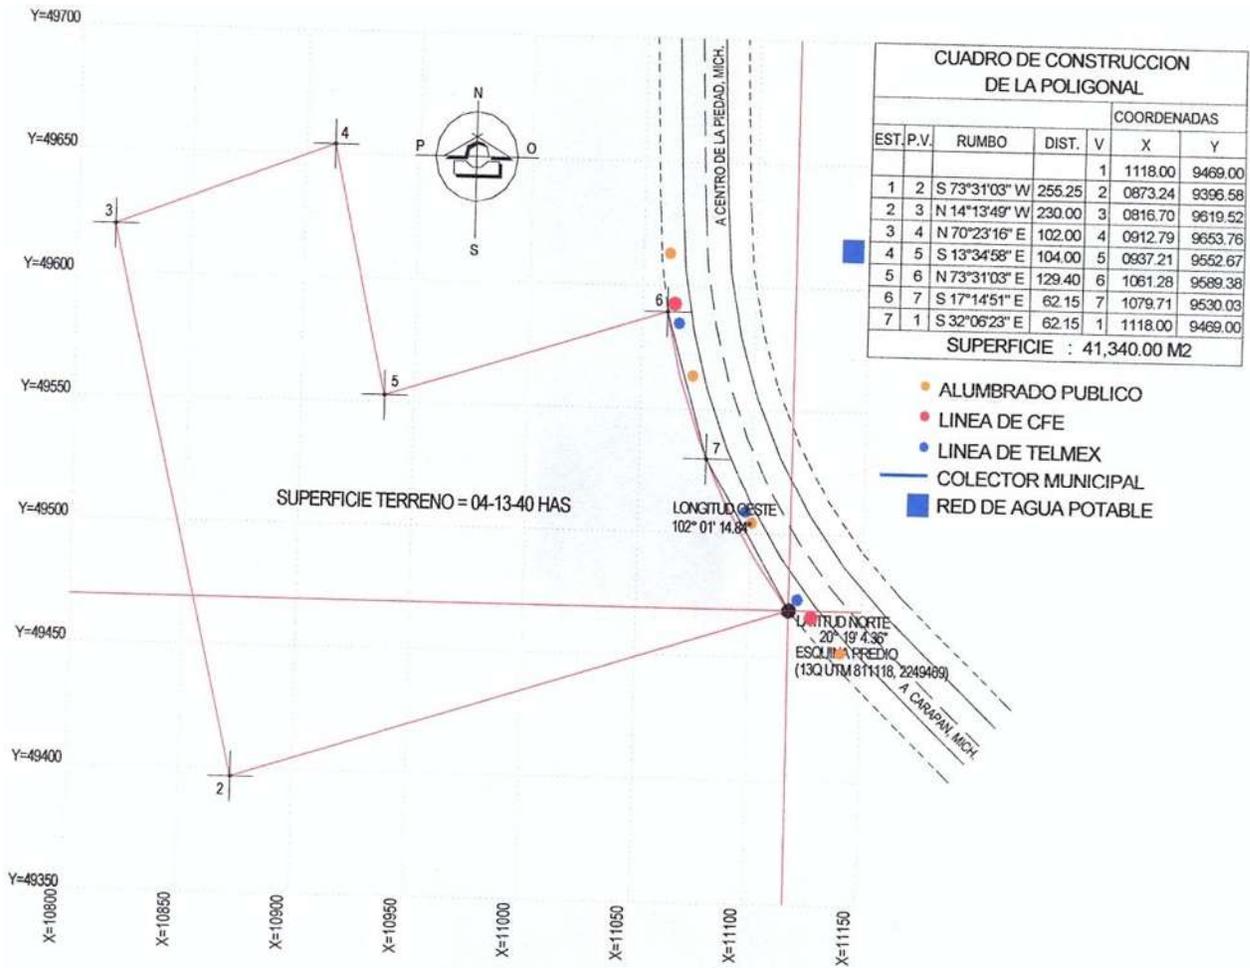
Croquis del levantamiento topográfico de la propuesta de terreno No. 3.
